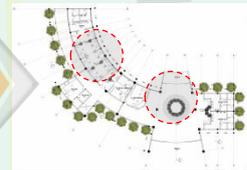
Denah Pengelola lantai 1 dan 2
